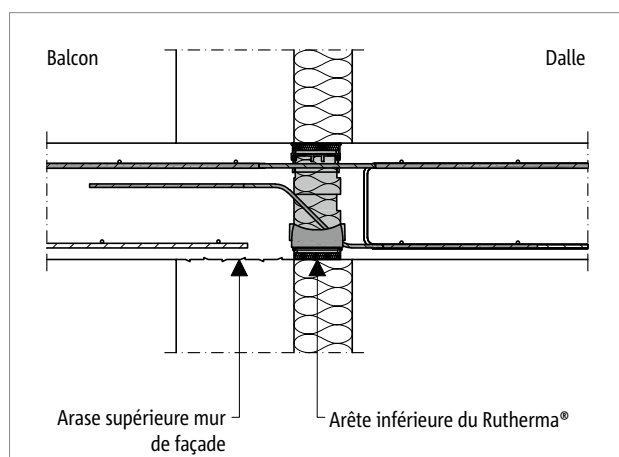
Schöck Rutherma® T type DBi : balcon en béton coulé sur place avec dalle en béton coulé sur place sur mur en béton armé
